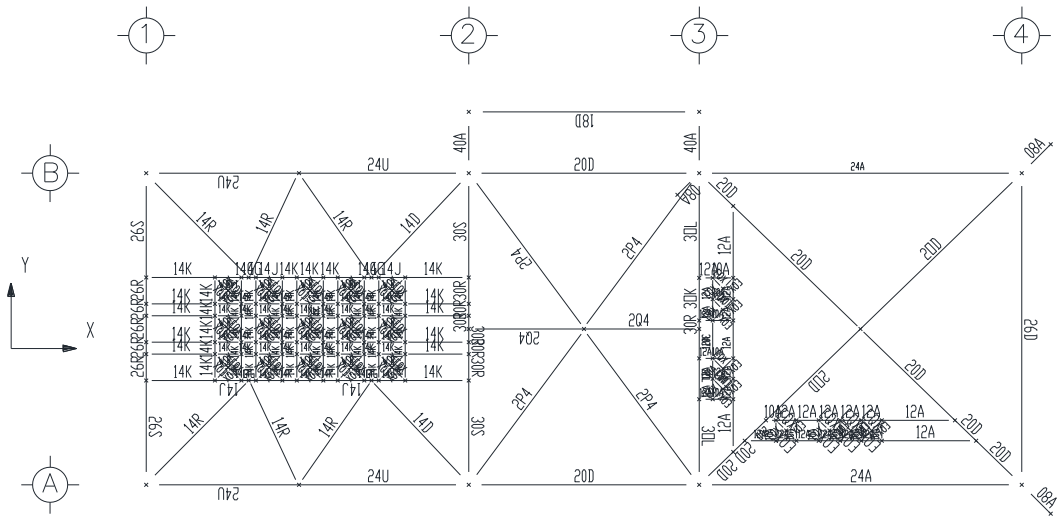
Grupos en Elev. (-) 12.192 m, subestructura
